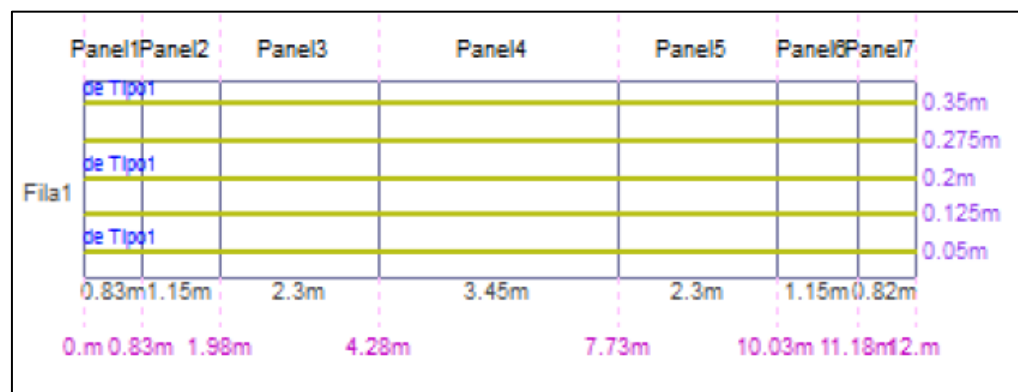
Detalle del despiece en la sección longitudinal de una viga.
